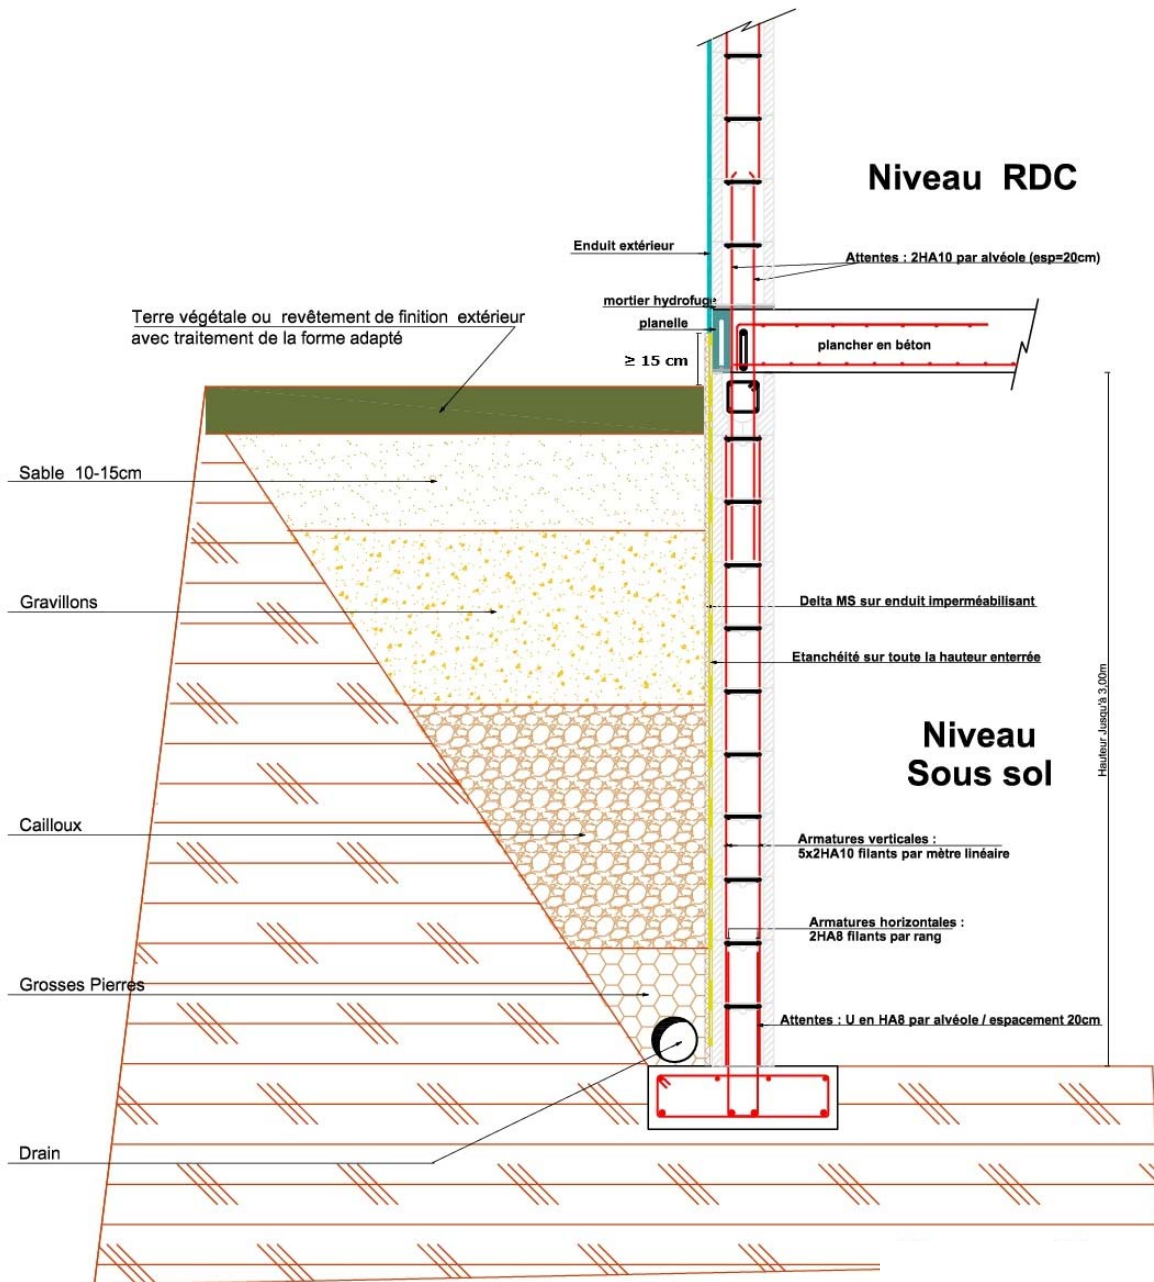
Ferrailage vertical et horizontal – Soutènement (blocs 600x200x200) sur semelles avec bêche
